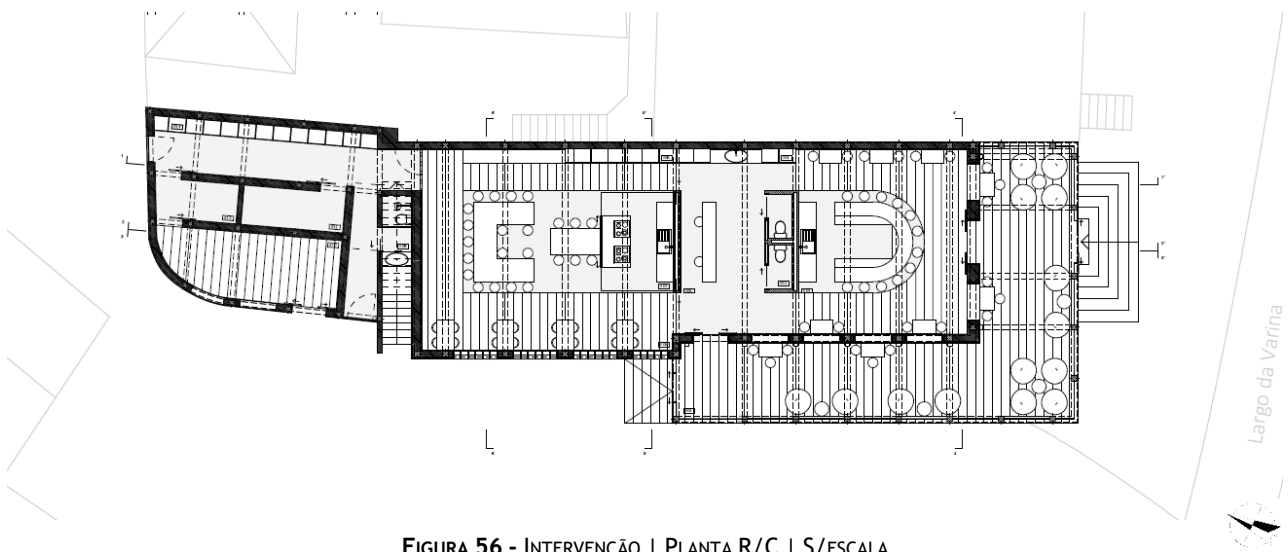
INTERVENÇÃO | PLANTA R/C | S/ESCALA
